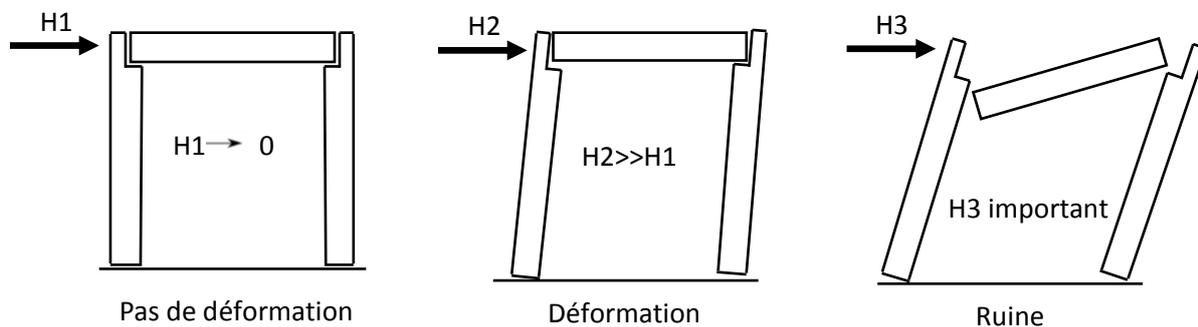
Comportement d'une construction sous sollicitation horizontale
